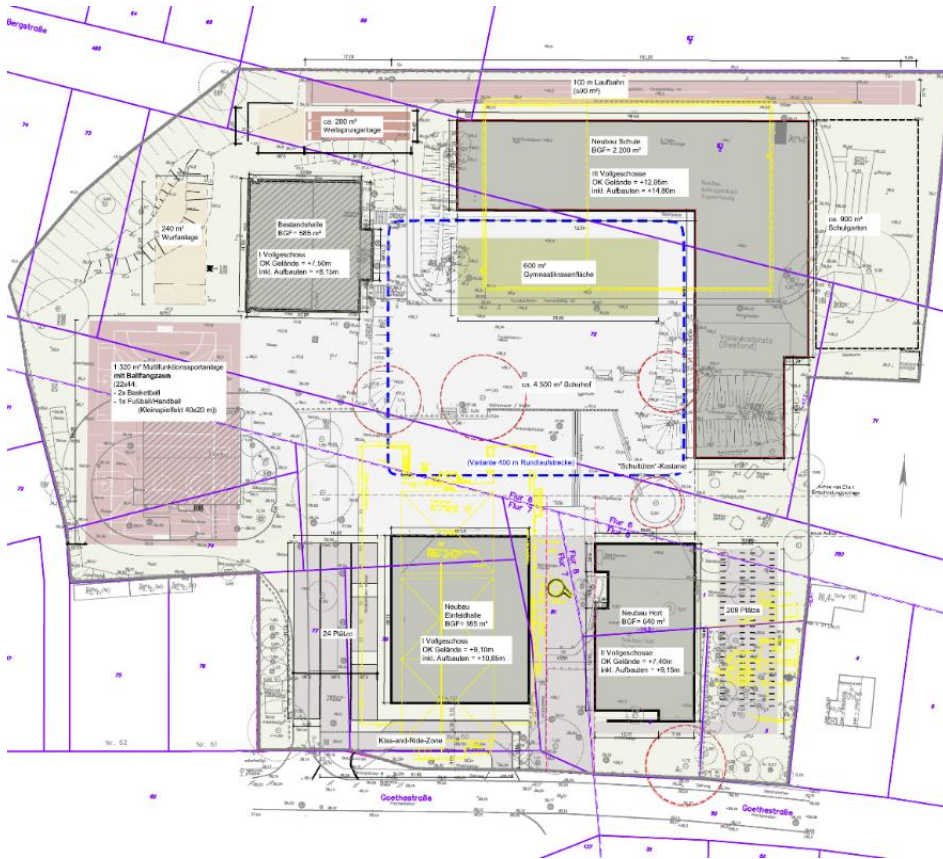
Objektbezogener Lageplan Variante 1²⁵
